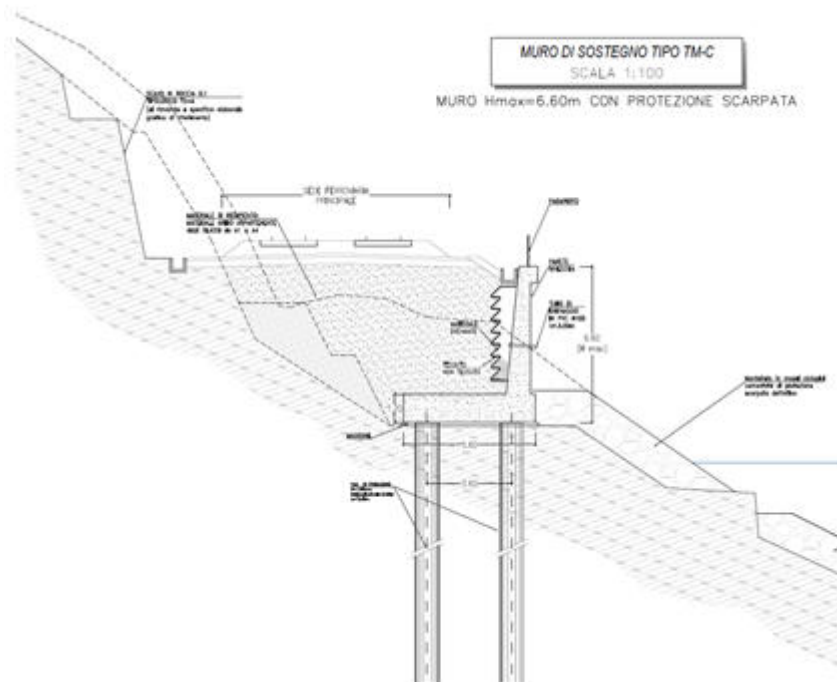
Sezione tipologica muro con fondazione su pali TM-C
